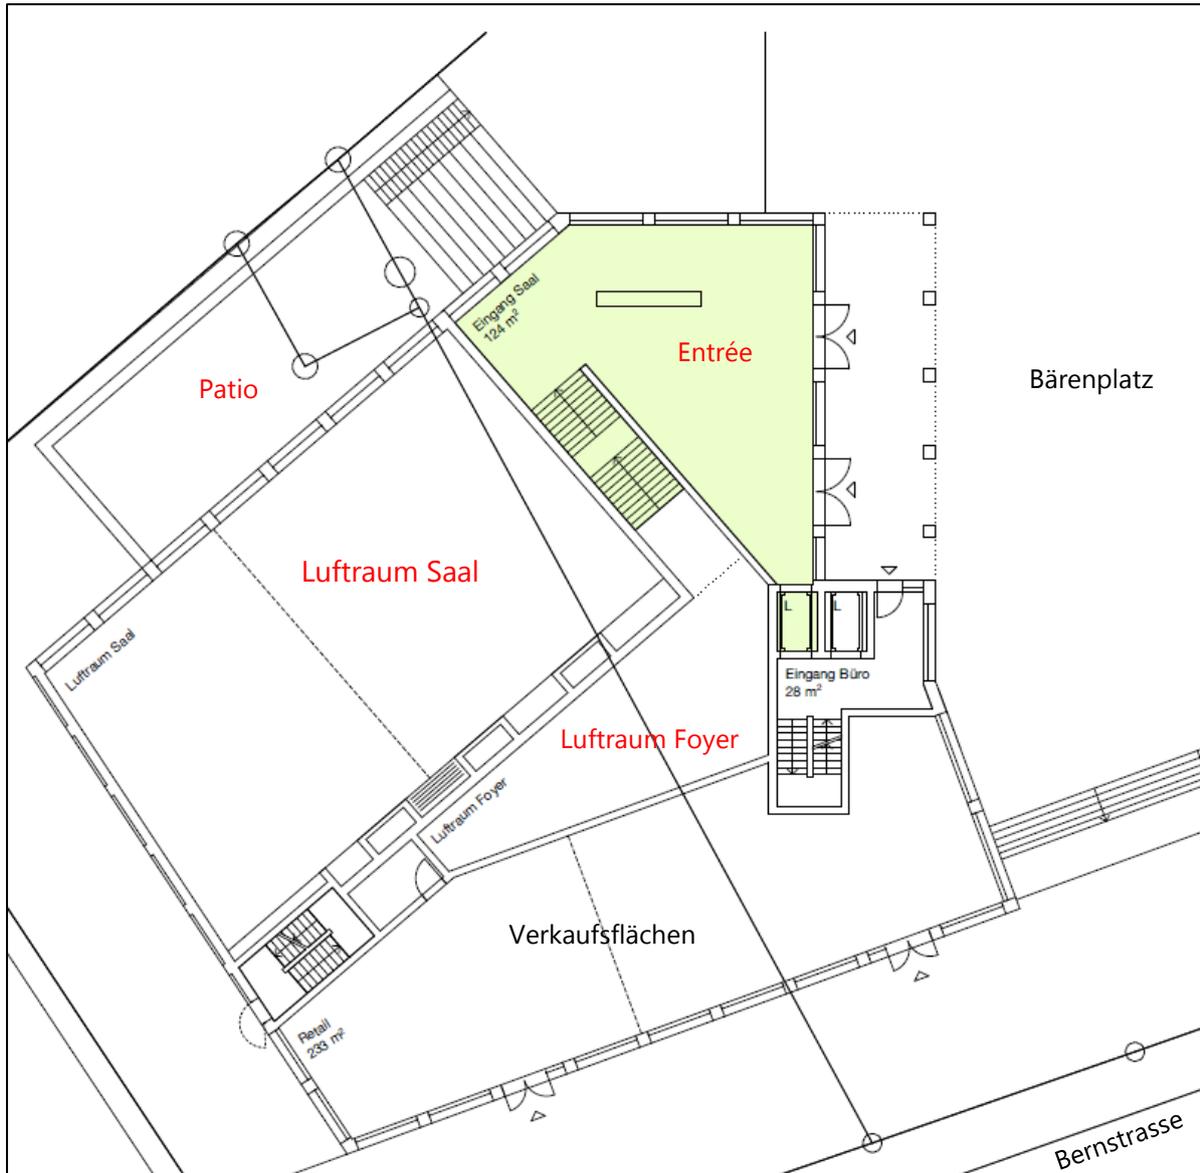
Grundriss Erdgeschoss Gemeindesaal
